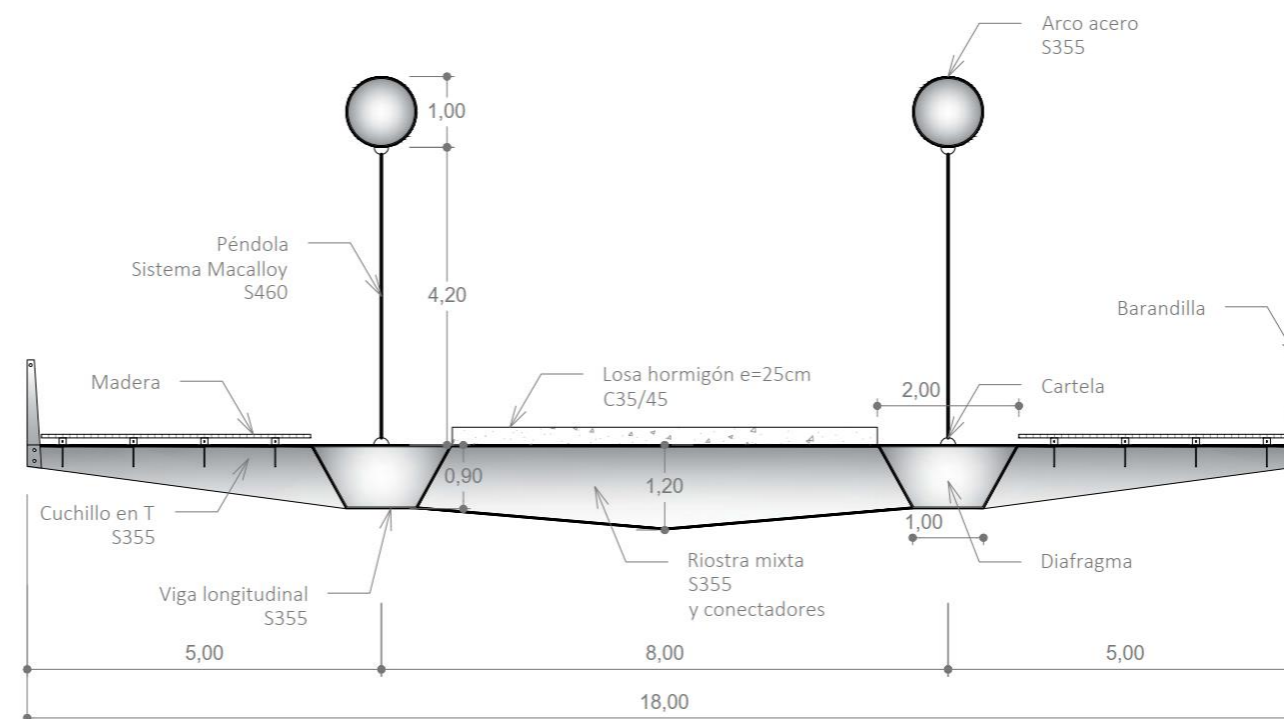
Sección transversal alternativa 2 puente arco (fuente: elaboración propia)
